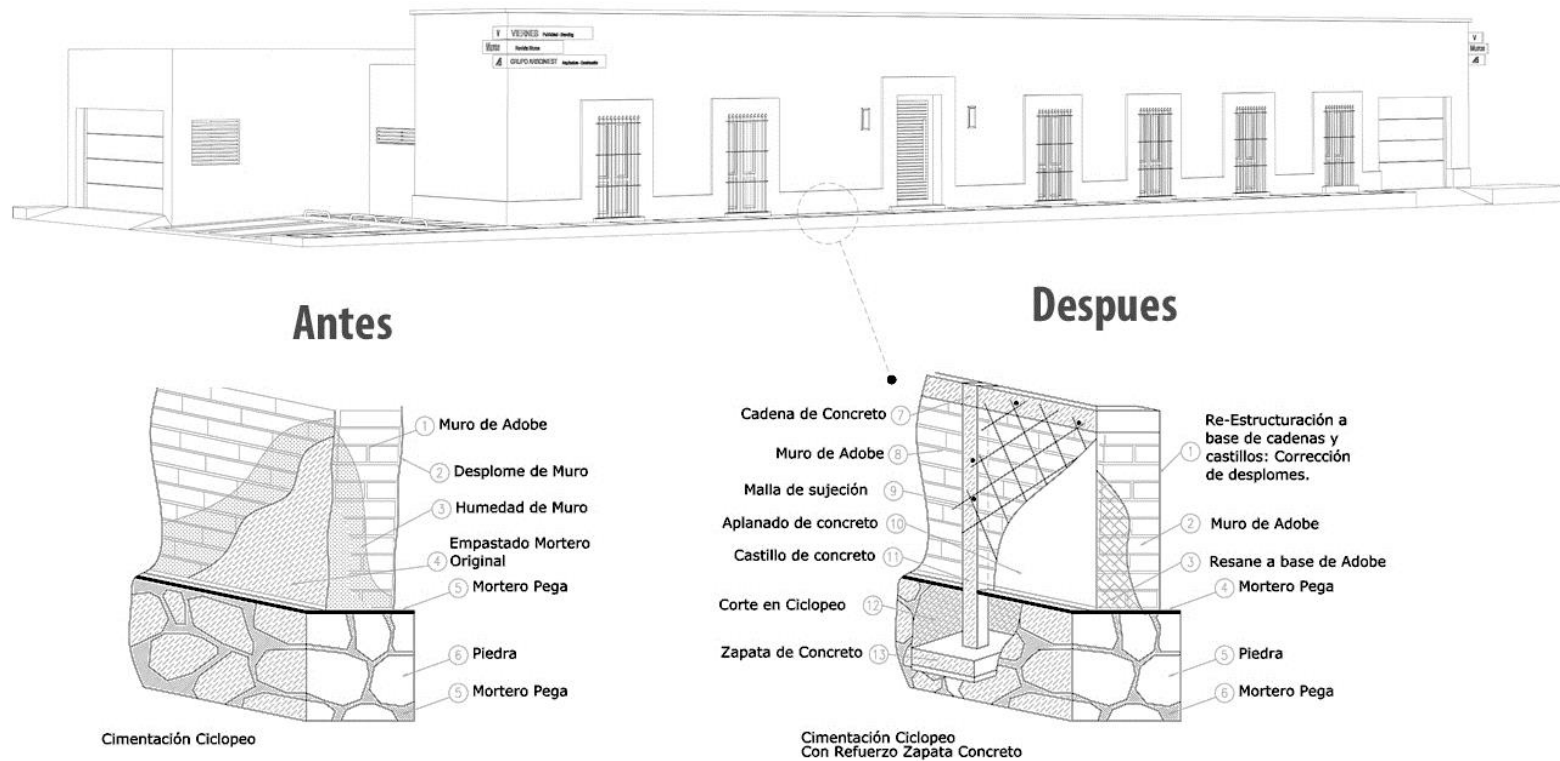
Refuerzo de cimentación- Corte por fachada (Flores 2014)
